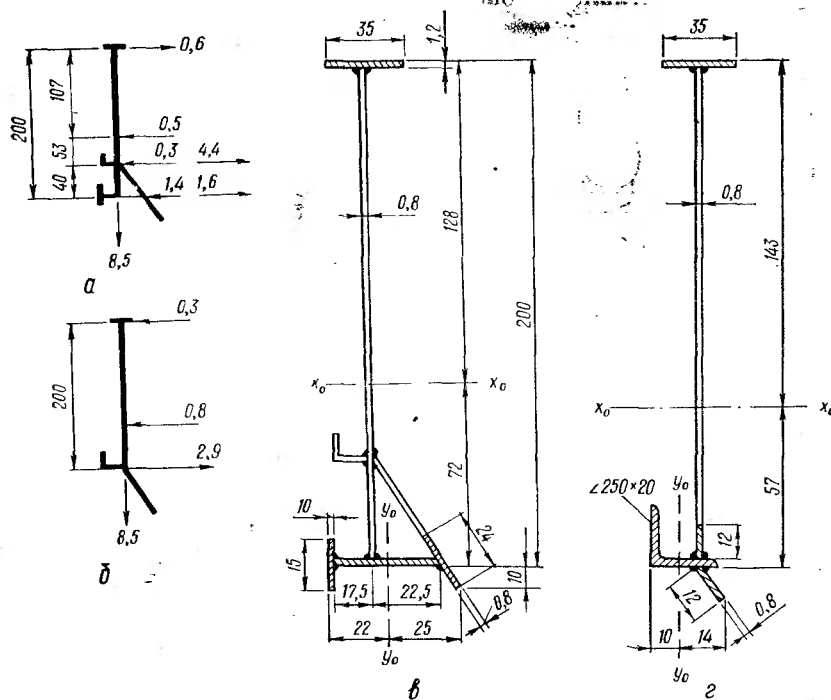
К примеру 7.5. Схема действия нагрузок (в тс) на балки (а, б) и поперечные сечения балок (в, г). Размеры в см.
